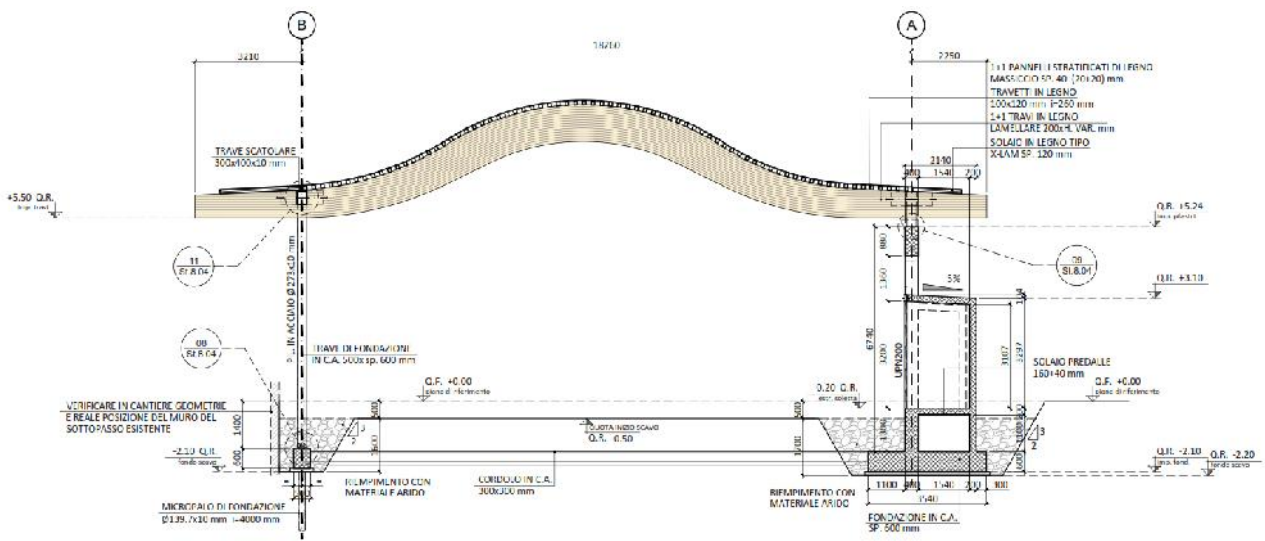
Sezione trasversale con vista degli elementi portanti dei box e delle fondazioni
